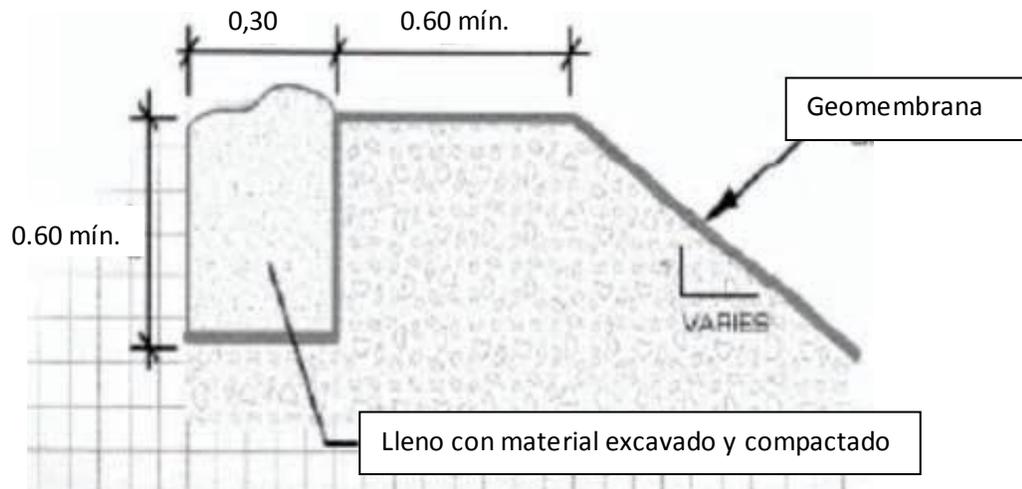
Detalle de anclaje de la geomembrana sobre la corona y el pie del terraplén
